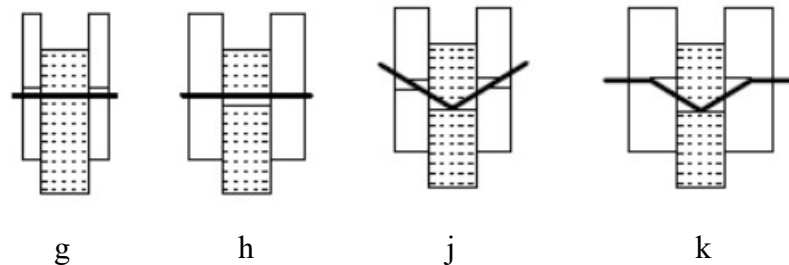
Tipos de rotura da ligação em corte duplo (EN 1995-1-1, 2004)
